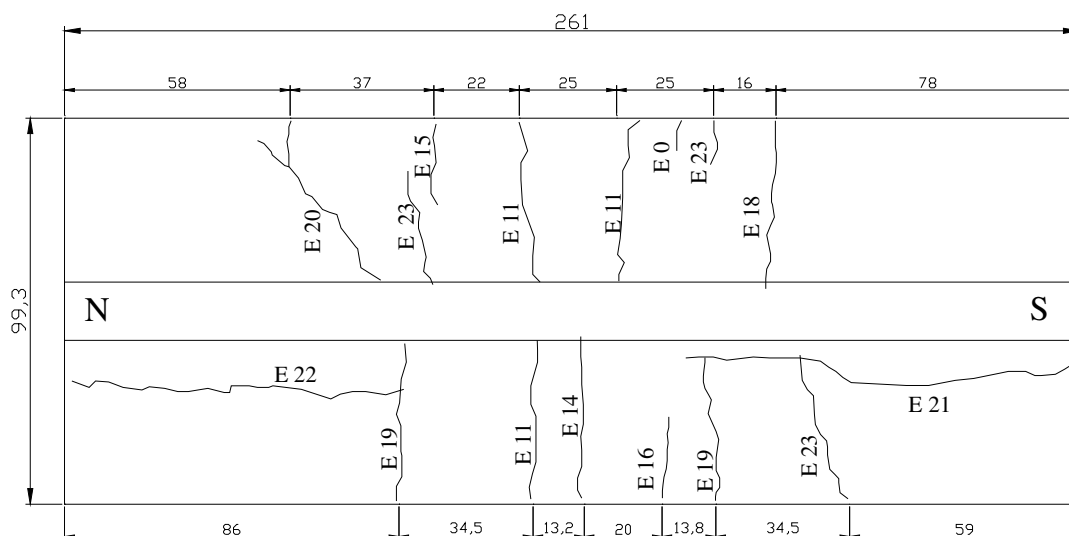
Fissuras do modelo 1BE (Face inferior da laje) – medidas em cm.
